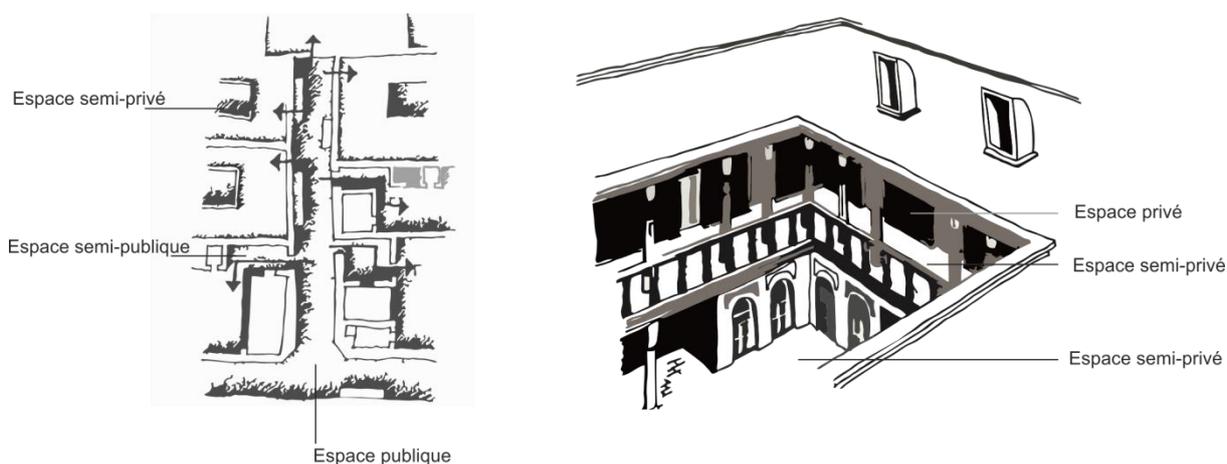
gauche : espace public et privé dans une ville Arabo-islamique traditionnelle ; [Ragette, 2006] ; retracé par l'auteur. Figure 4-2 : droite : cour dans une maison à Bagdad, avec loggia ou Ivan, des balcons au premier étage et Badgir sur le toit ; par l'auteur d'après [Oliver, 2007].
